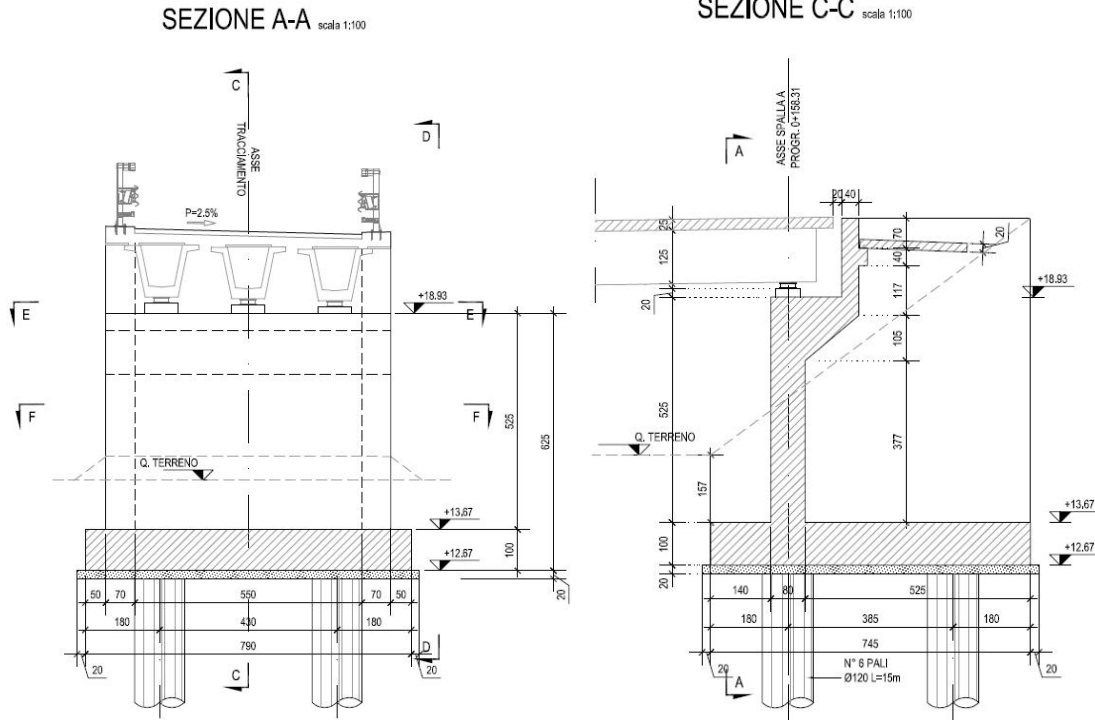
Sezione di carpenteria - Spalla tipo
